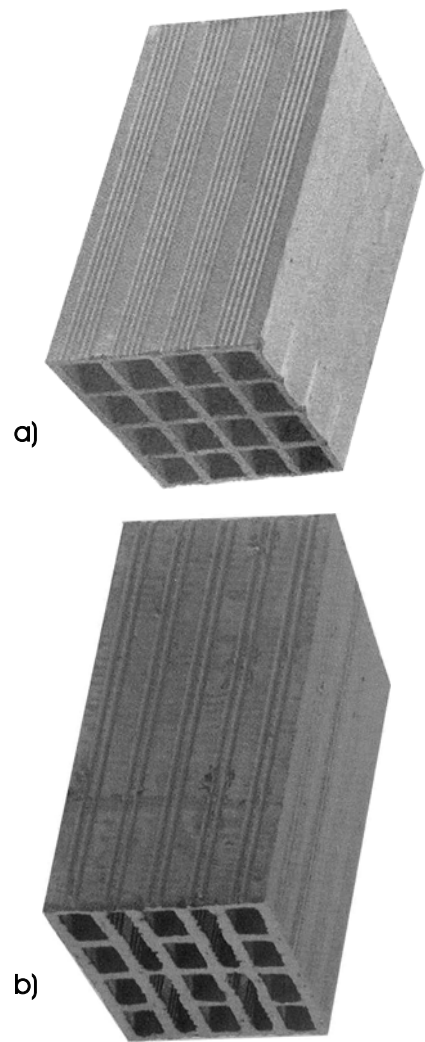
Exemplos de Tijolos furados: a) tijolo de 22cm, b) tijolo triplex
